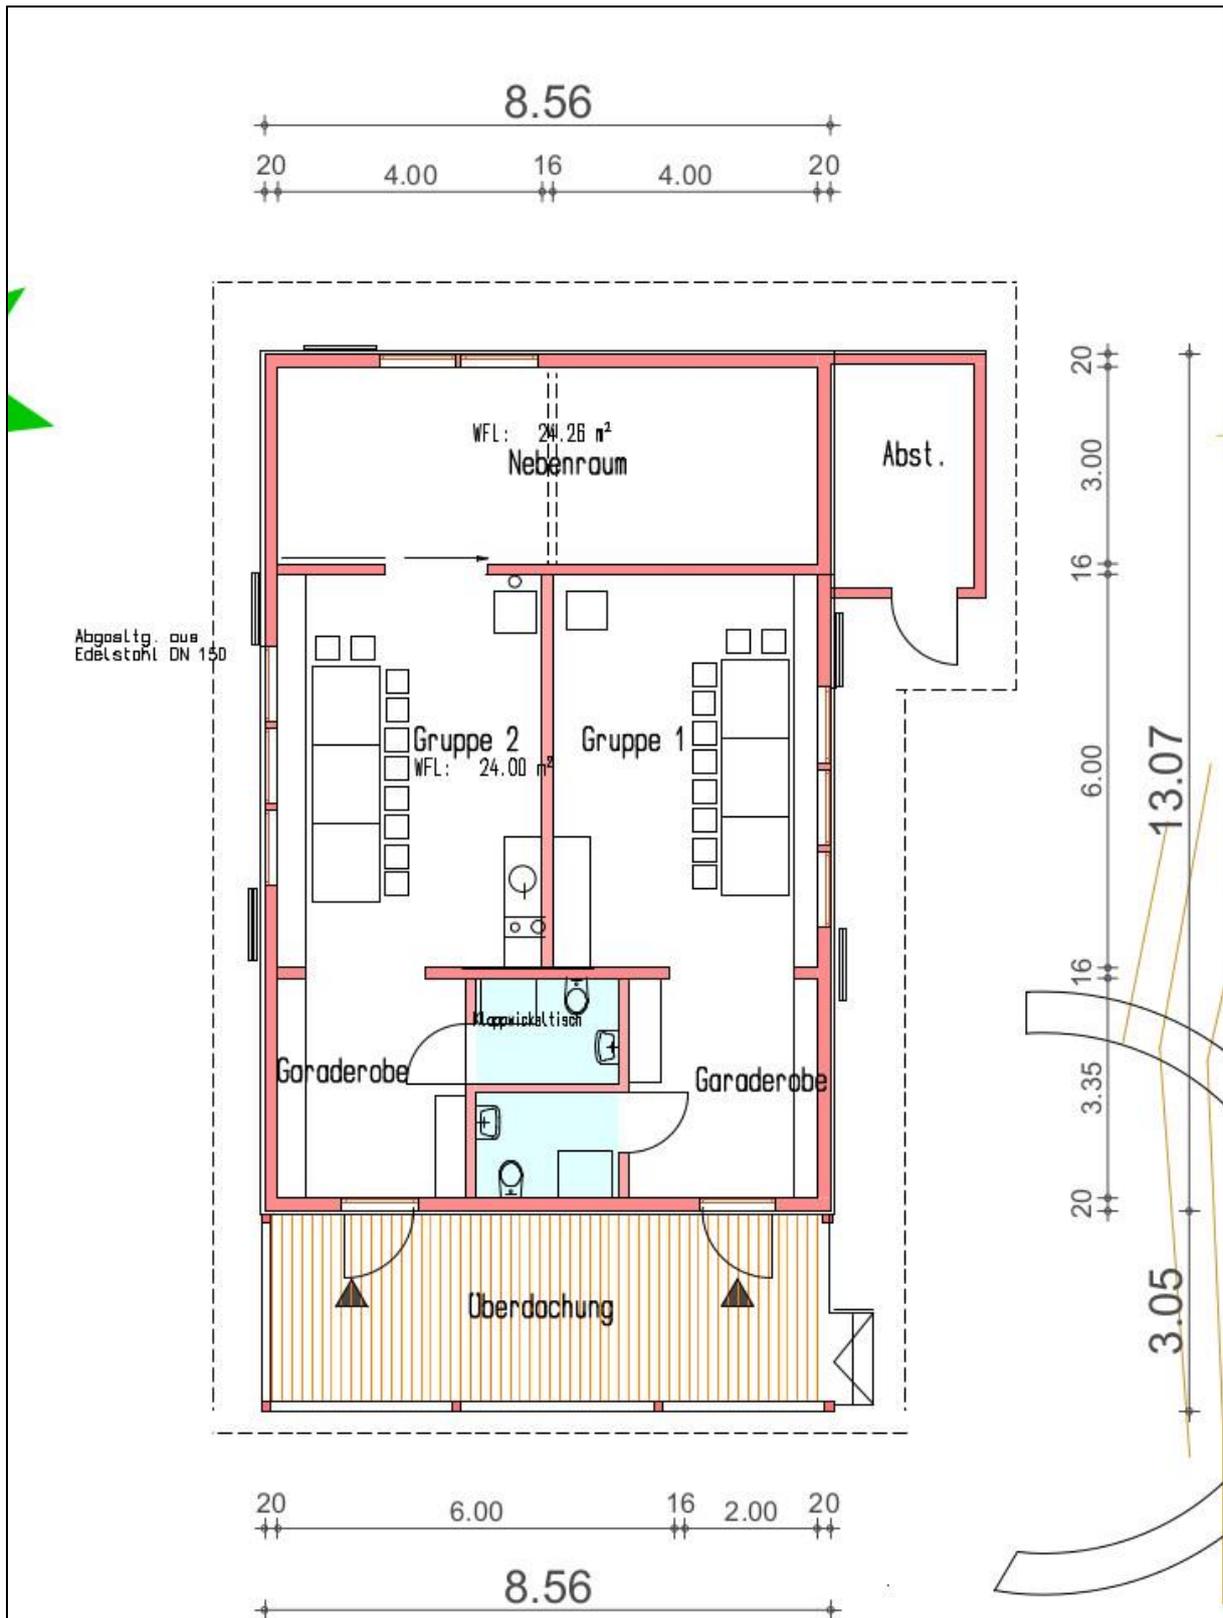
Gebäudegrundriss Schutzhütte (UTE HÖLLE Januar 2023)
